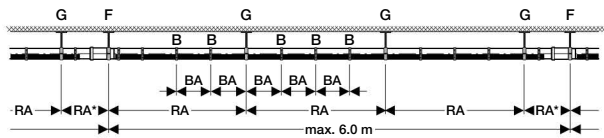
Befestigungsabstände an Decken, mit Tragschalen
